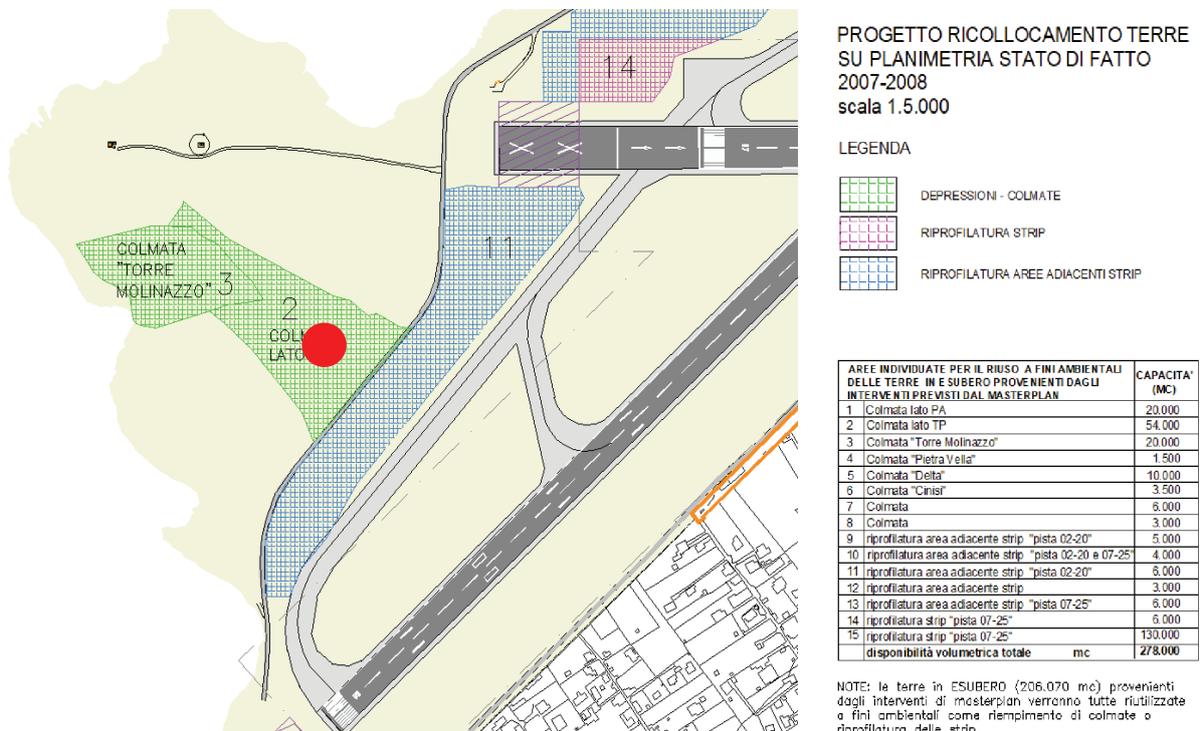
Stralcio Masterplan Aeroportuale – Tav. QPG. 09 – Progetti ricollocamento terre su planimetria stato di fatto 2007-2008 (in rosso il sito del nuovo radar).
